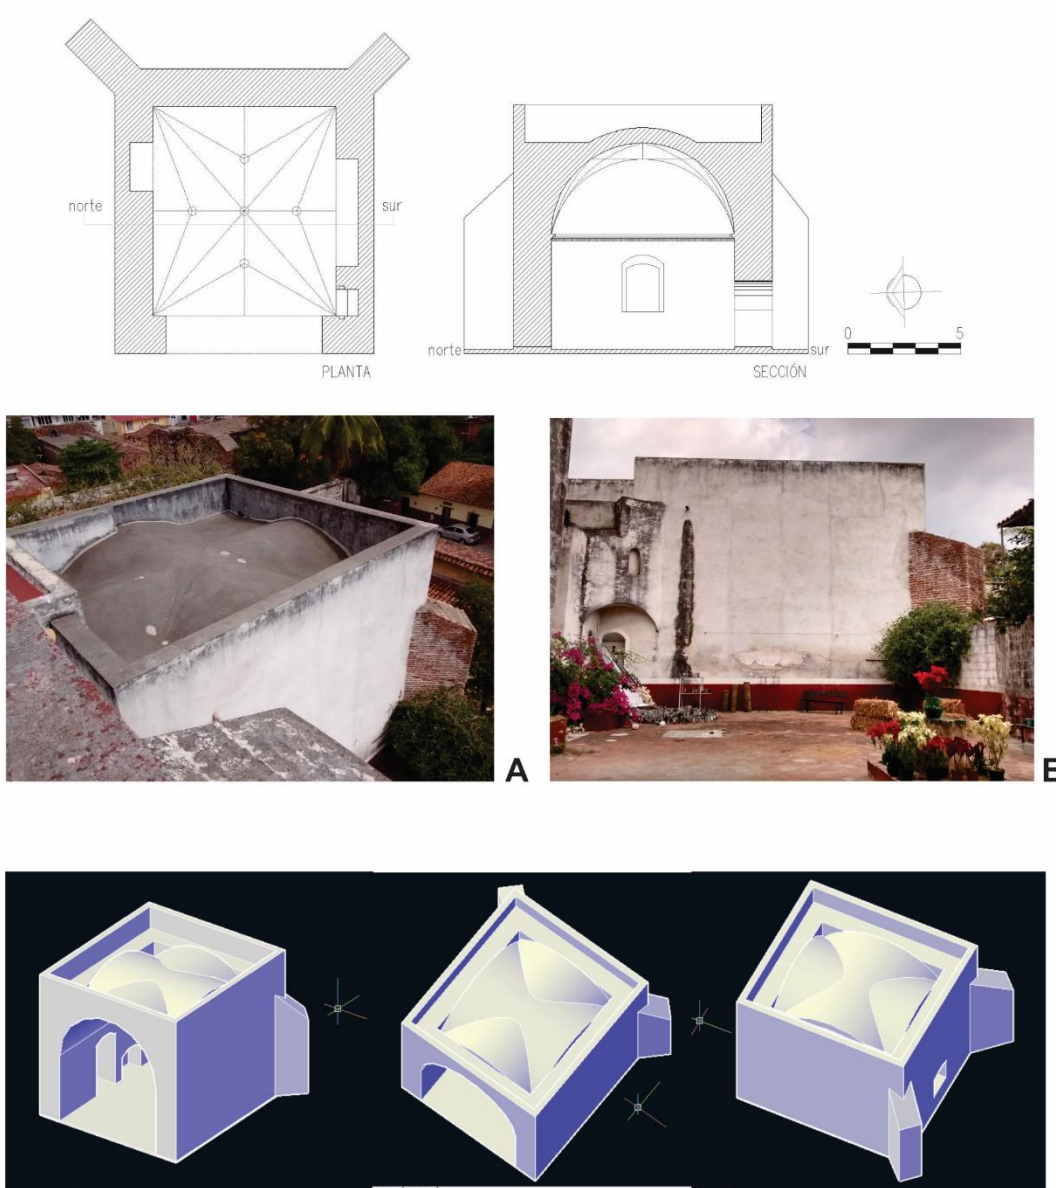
La capilla mayor de la Villa de Tehuantepec. En la imagen se presenta la planta arquitectónica y sección transversal. La fotografía A es una vista de la capilla desde la azotea del templo conventual. La fotografía B es su fachada sur vista desde el patio del convento. Por último, la reconstrucción hipotética. c. 1538-1540. Levantamiento, fotos y modelos virtuales del autor.
